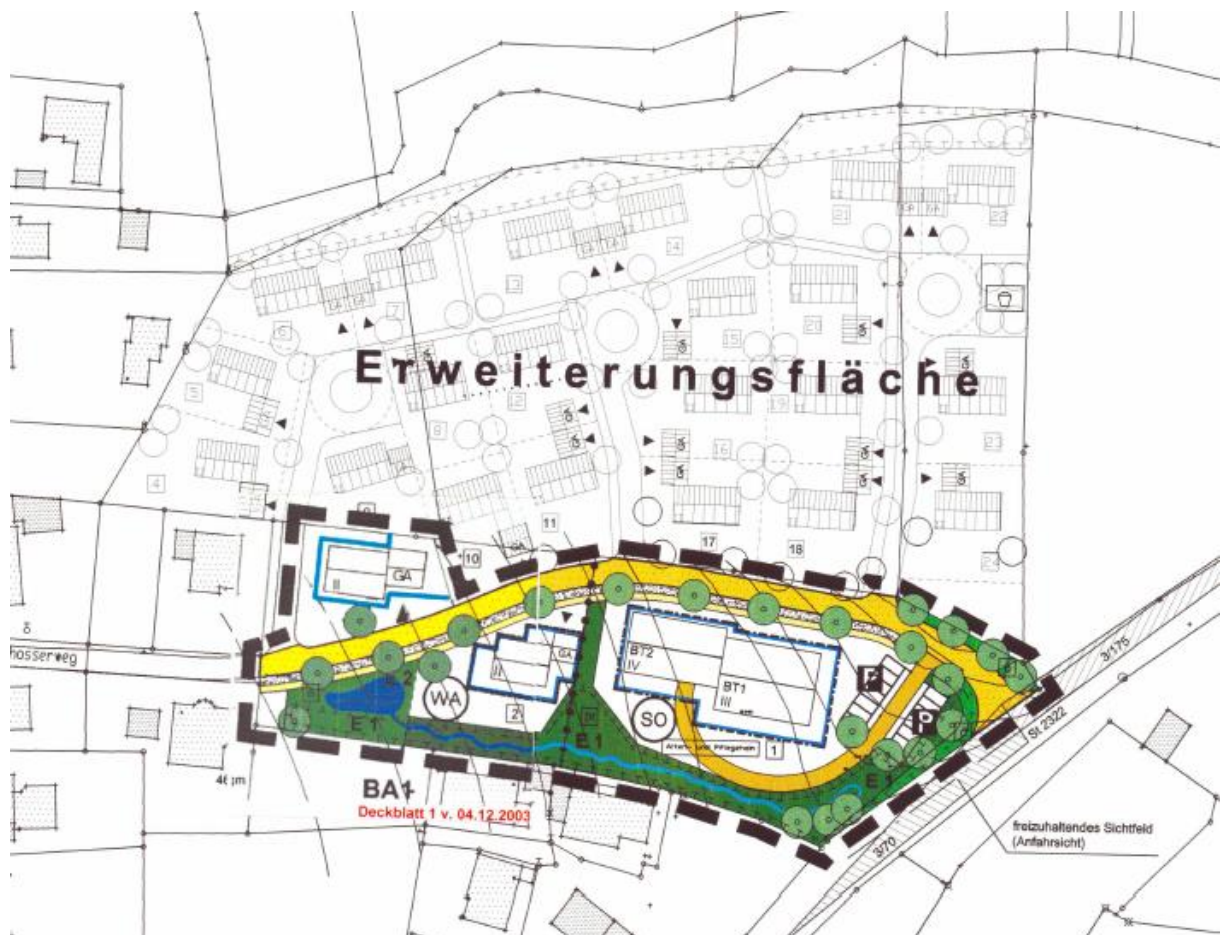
Ausschnitt BBP "Kapellenpoint BA1" mit angedachter Erweiterung in Richtung Norden
